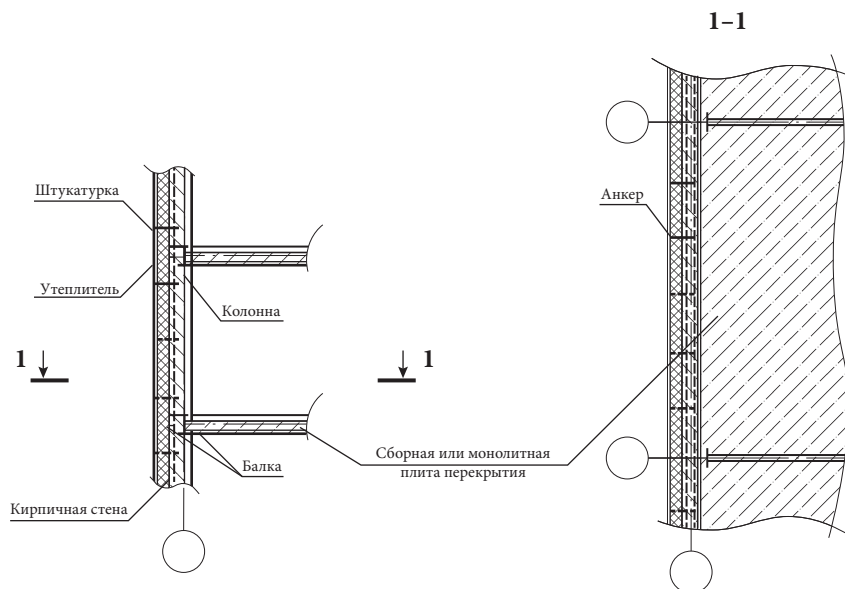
Наружная стена с опиранием кирпичной части на балку перекрытия и контурную балку
